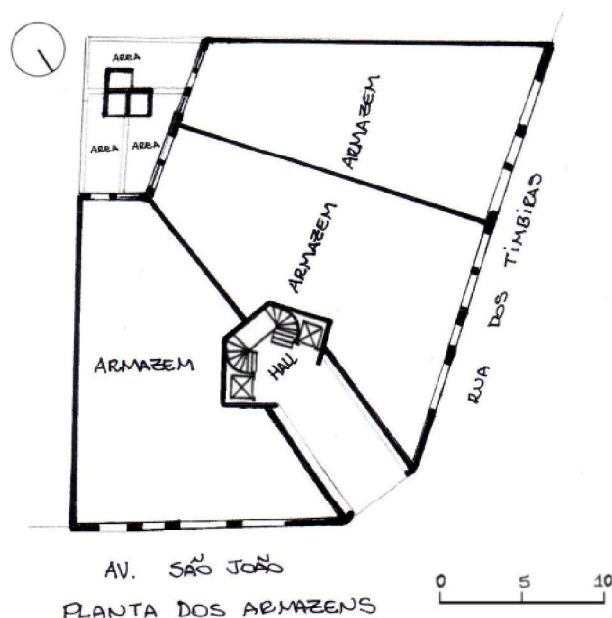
Reprodução da planta do Pavimento dos Armazéns do Edifício Livia Maria.
